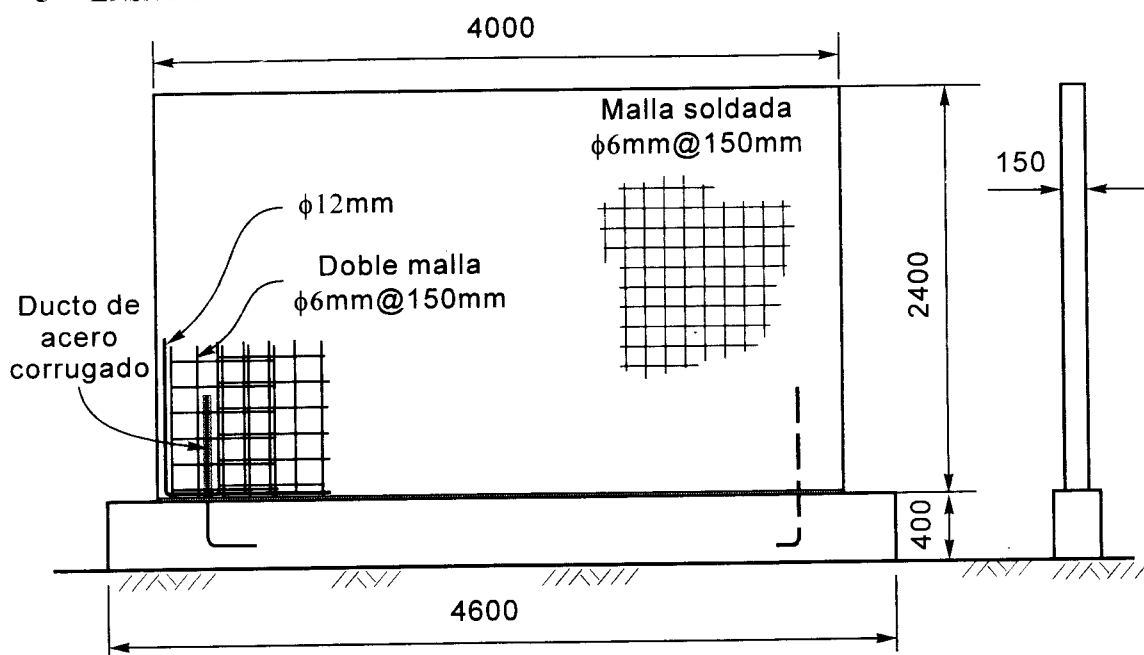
Detalle de la armadura de refuerzo del panel y de la conexión
